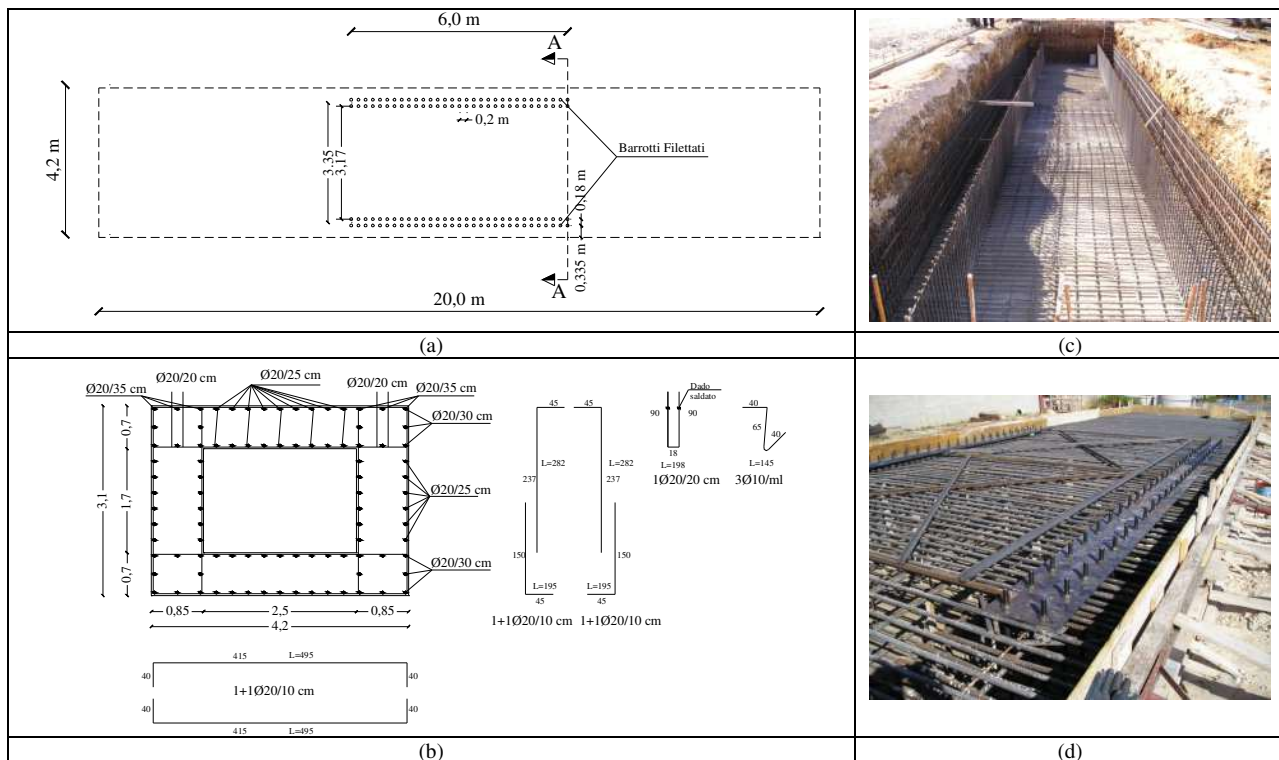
Laboratorio "a cielo aperto": pianta della trave di fondazione (a); caratteristiche geometriche della trave di fondazione (b) fasi realizzative (c) e (d)
